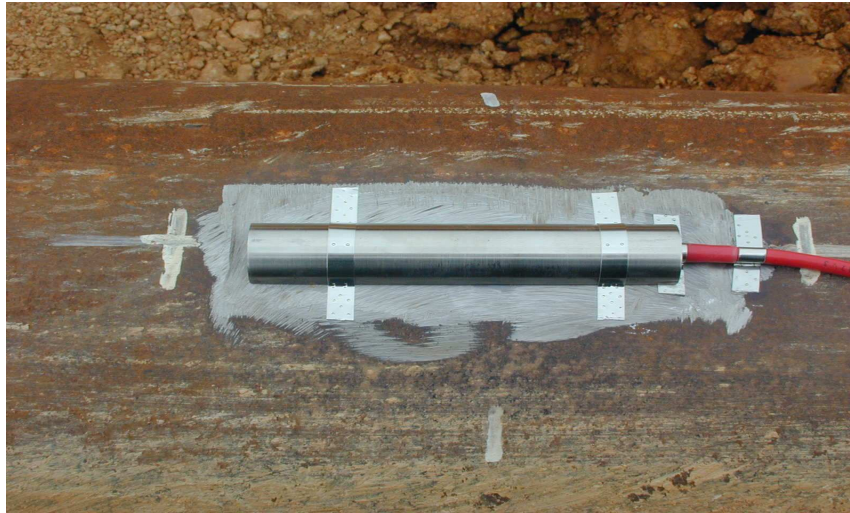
Soldadura por puntos en la cubierta protectora
